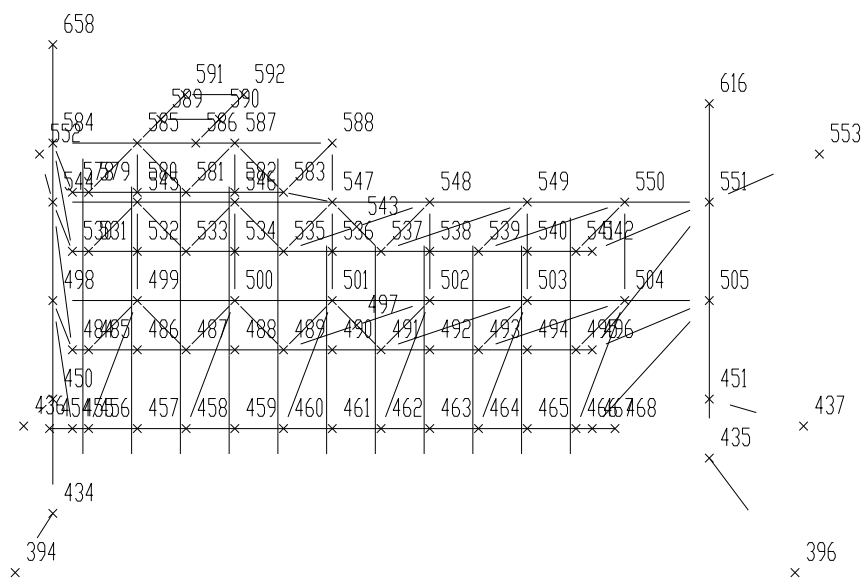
Planta cubierta principal elev (+) 19.100 m.
